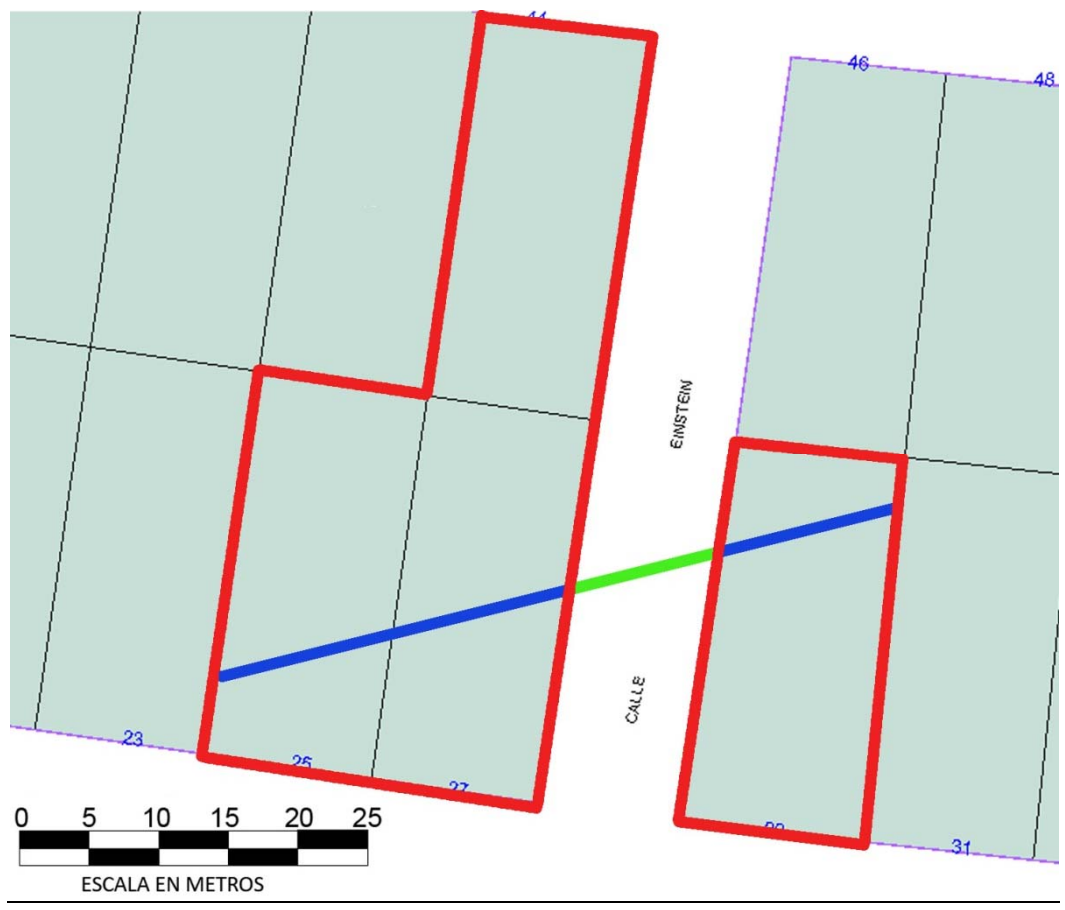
Trazado de la tubería E I a lo largo de las parcelas intervenidas (en azul) y sección ausente por la construcción de los viales (verde).
